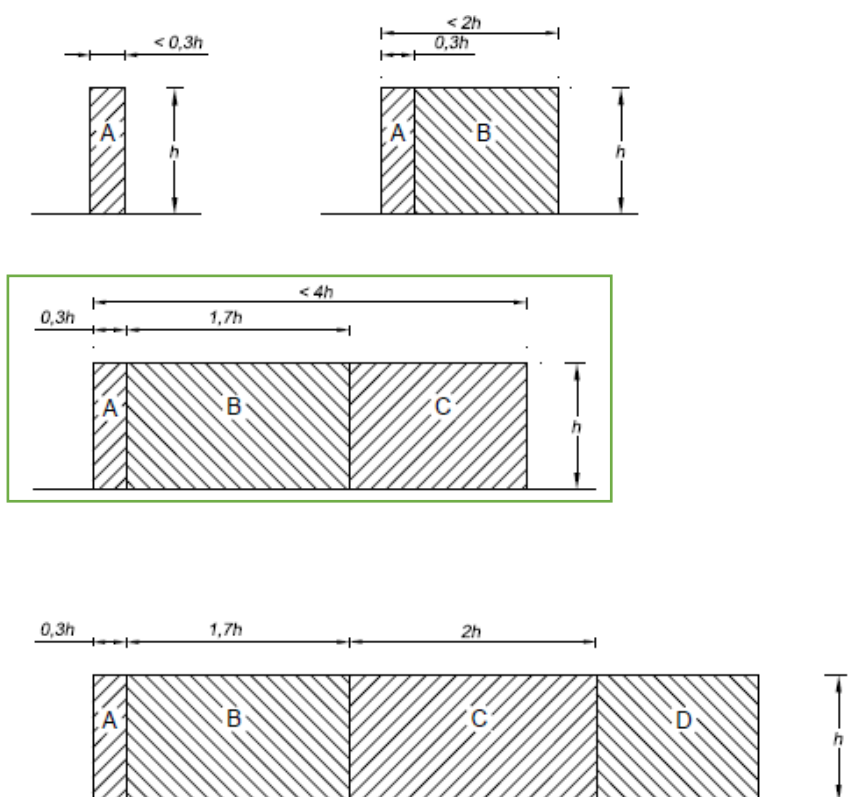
Suddivisione di muri e parapetti in aree di uguale pressione complessiva
